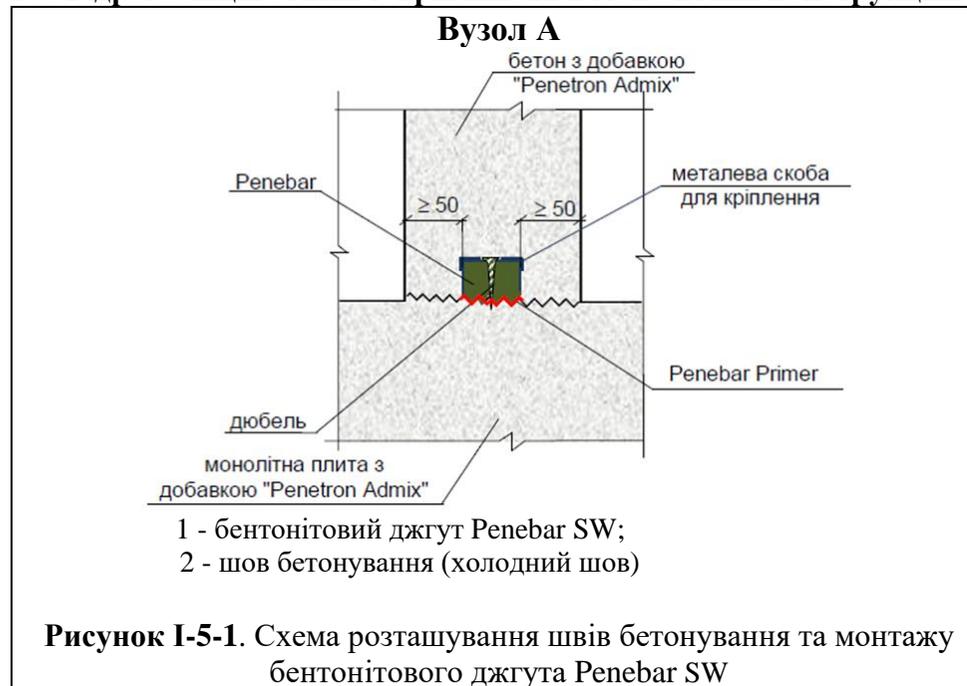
Схема розташування швів бетонування та монтажу бентонітового джгута Penebar SW
